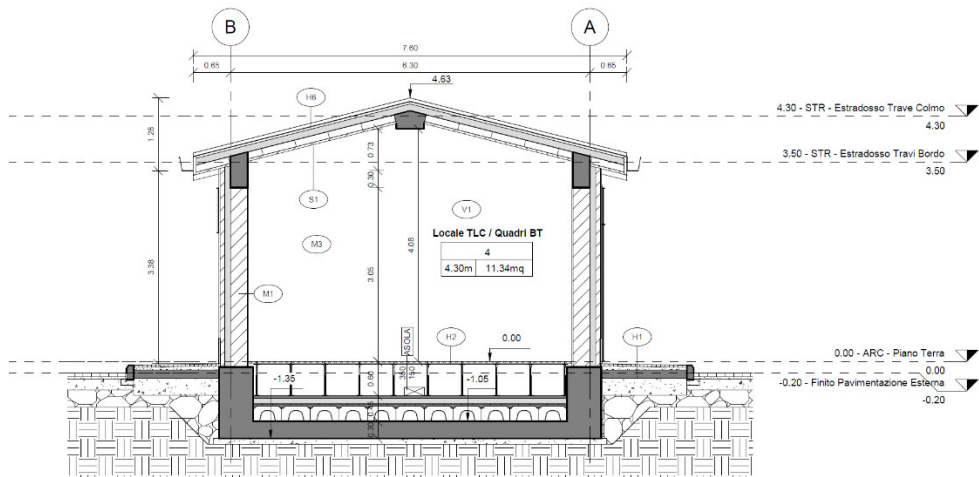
Sezione A - A – Layout Fabbricato FA01
